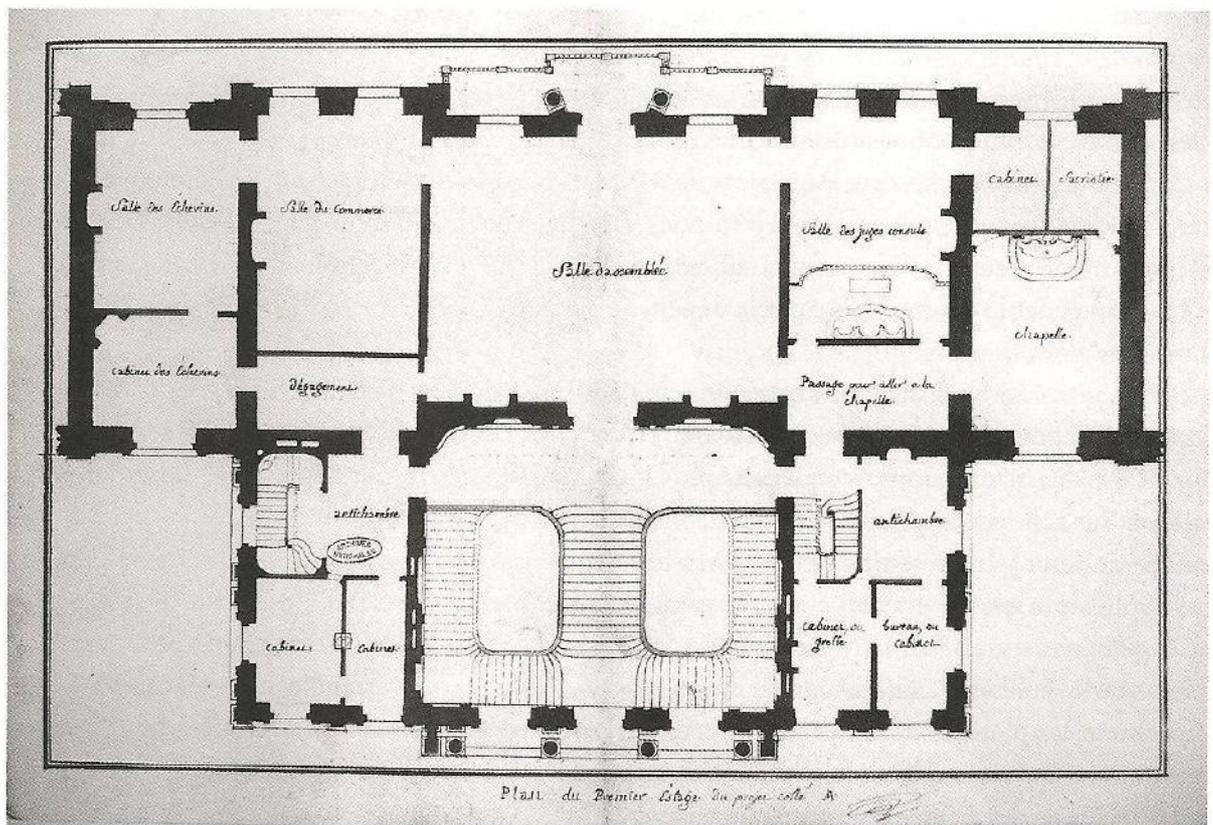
> Mansart de Sagonne : plan au premier étage du second projet avec double escalier central, 1748 [© AN, Cartes et plans].
